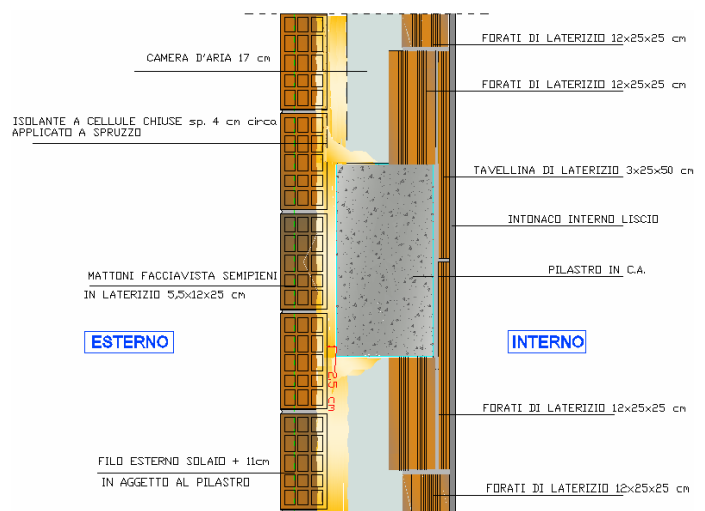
Sezione del campione in corrispondenza del pilastro in cemento.
